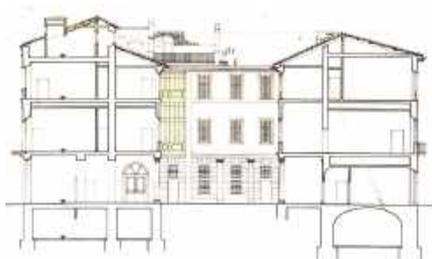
Sezione sud-est, stato di fatto prima dei lavori di restauro (rielaborazione)
